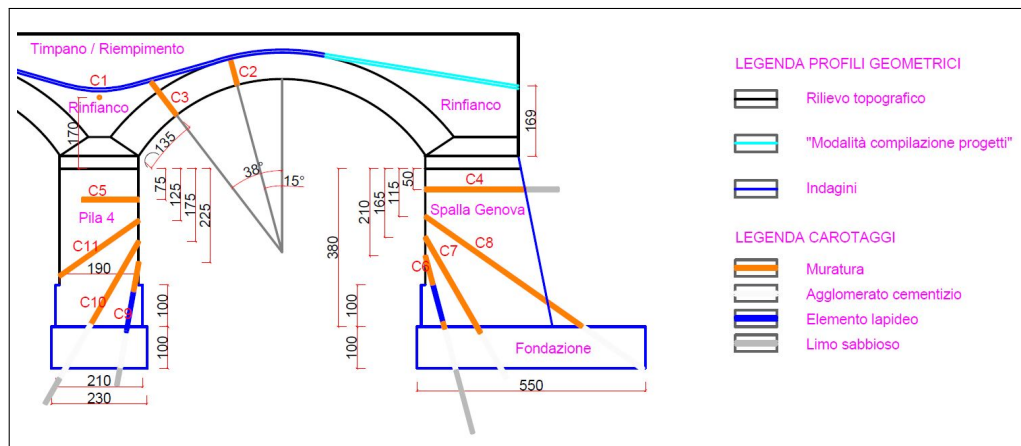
Sezione longitudinale della singola campata lato Genova
